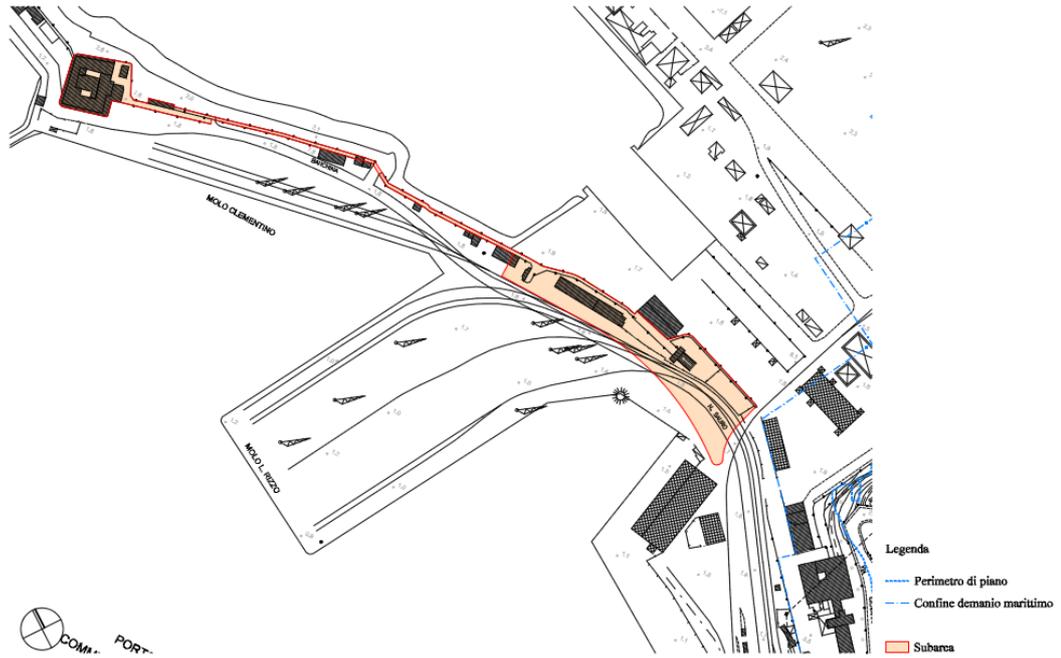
Subarea 1 (planimetria dello stato di fatto).
